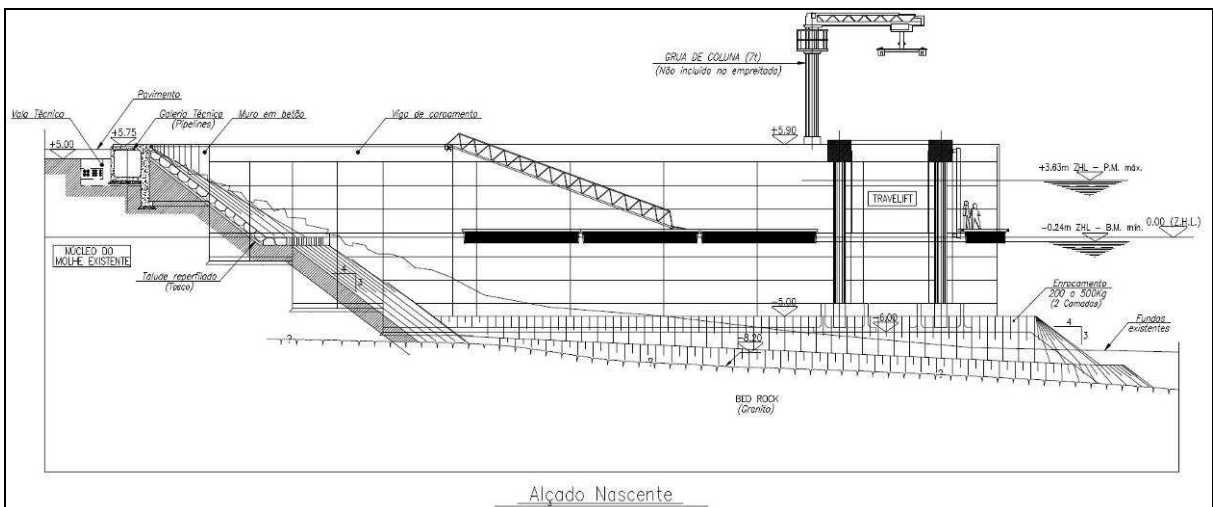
Alçado nascente do muro-cais em aduelas (imagem do projecto de execução).
